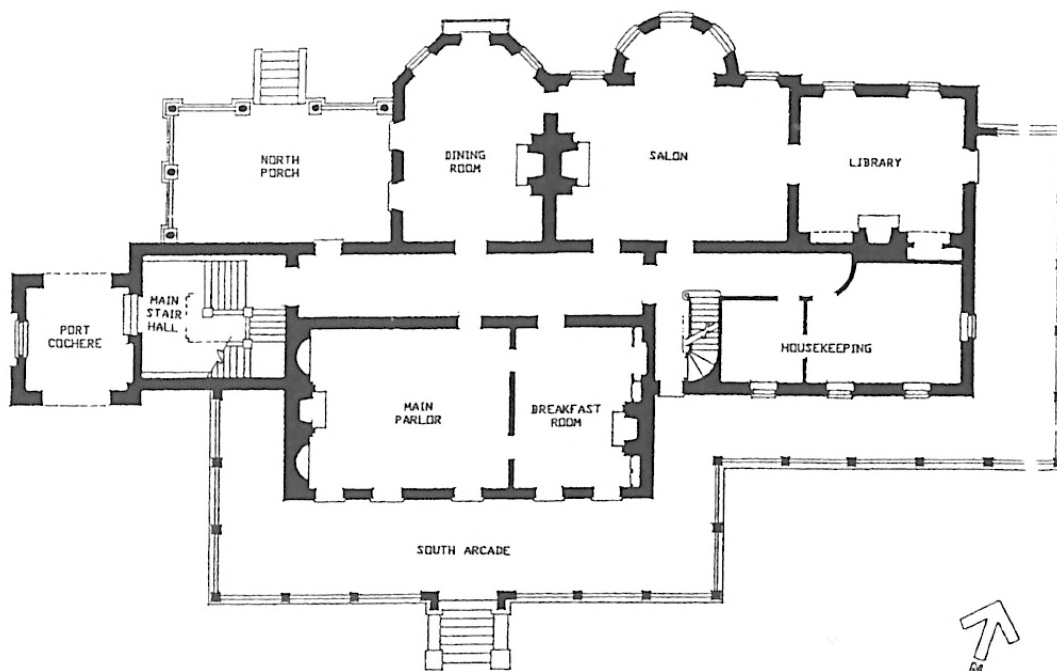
Grundriss Erdgeschoss (1852) o.M.
